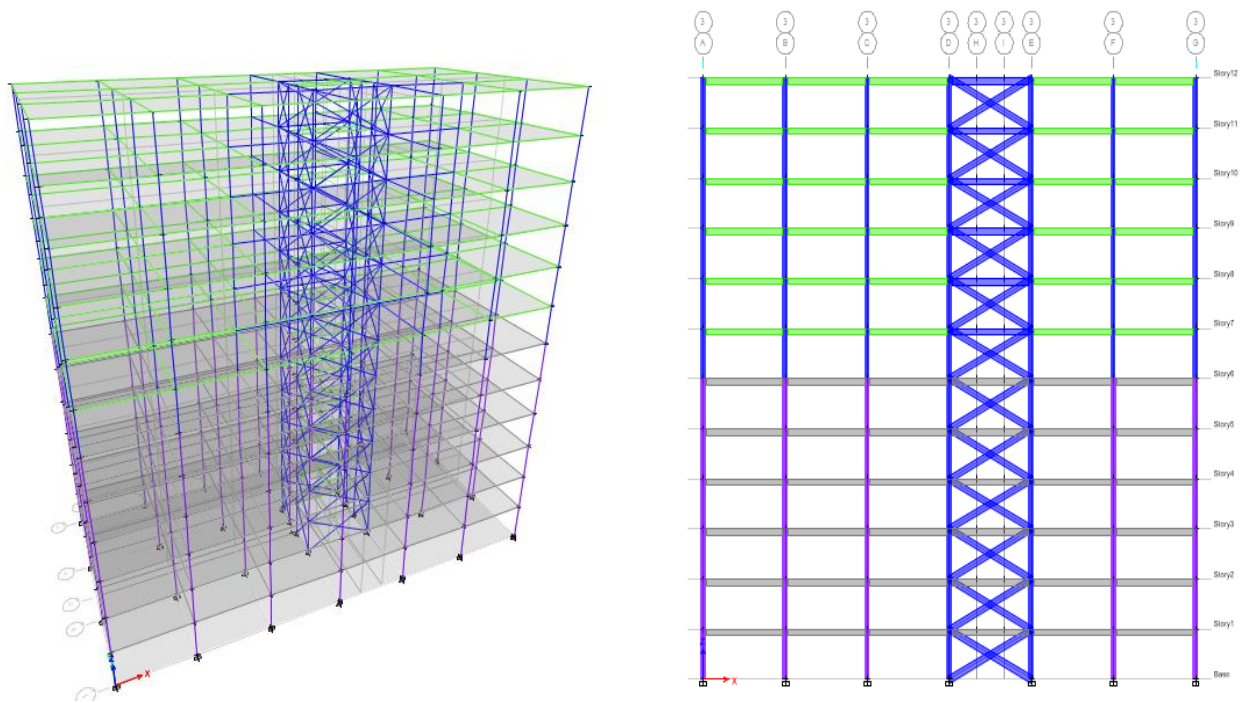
2: Edificio tipo A, núcleo arriostrado concéntricamente, vista 3D y elevación 3.
